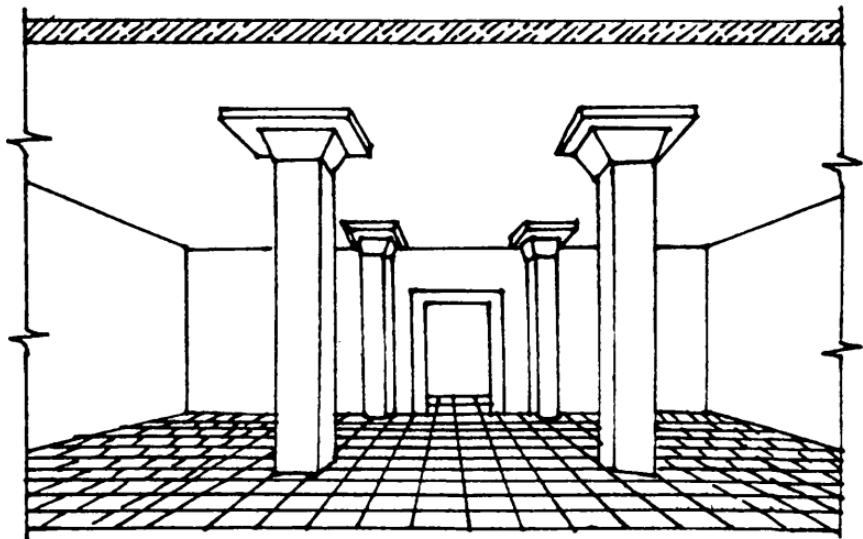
Общий вид железобетонного безбалочного монолитного перекрытия
